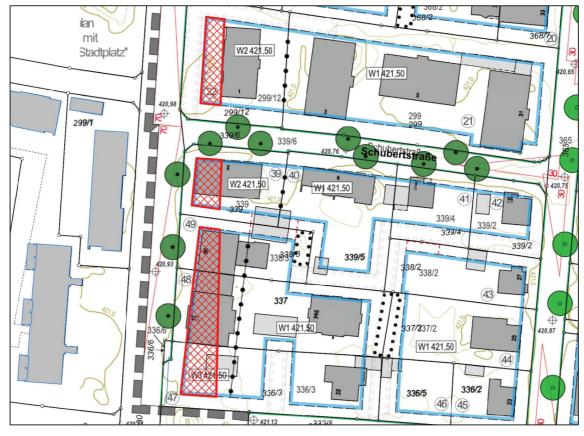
Lageplan mit Darstellung der von Schallschutz betroffenen Parzellen 22, 39 und 47 - 49
